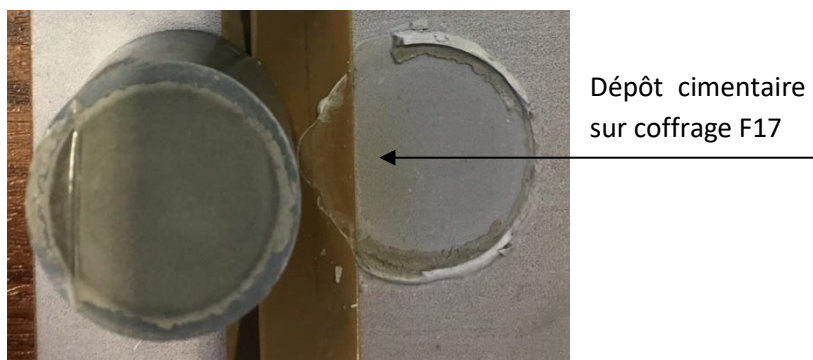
Dépôt cimentaire sur une surface coffrage F17, après un décoffrage à 24 heures suivant l'essai de préfissuration
